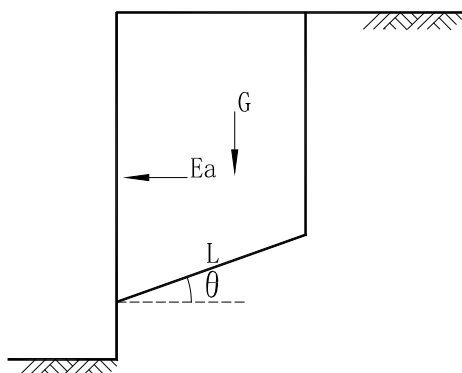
岩质边坡四边形滑裂时侧向压力计算
